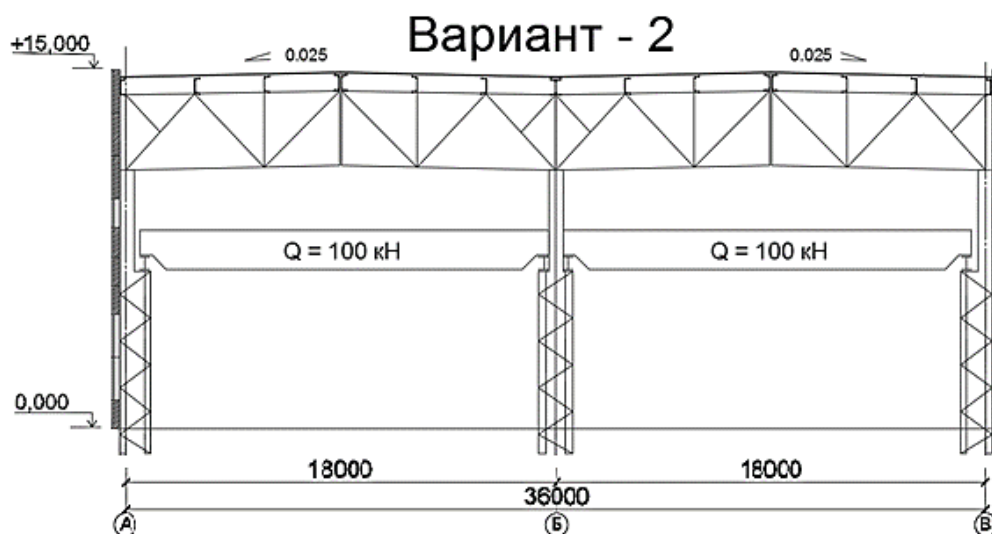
Схема поперечной рамы металлического каркаса здания
